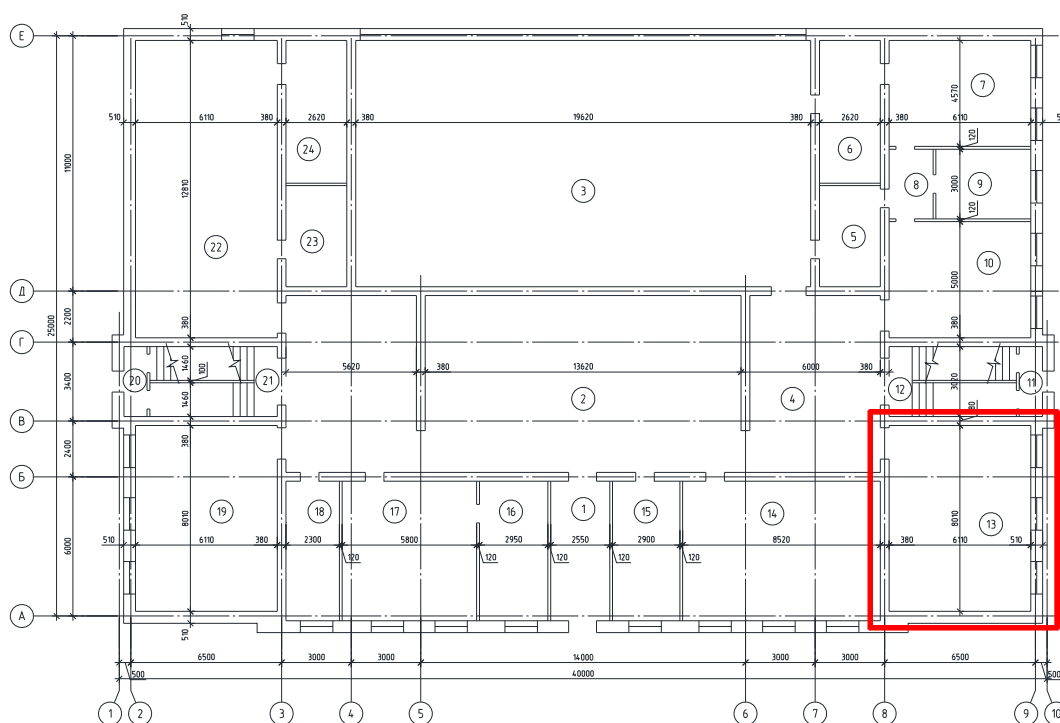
План этажа здания образовательной организации, проект 2-02-05
